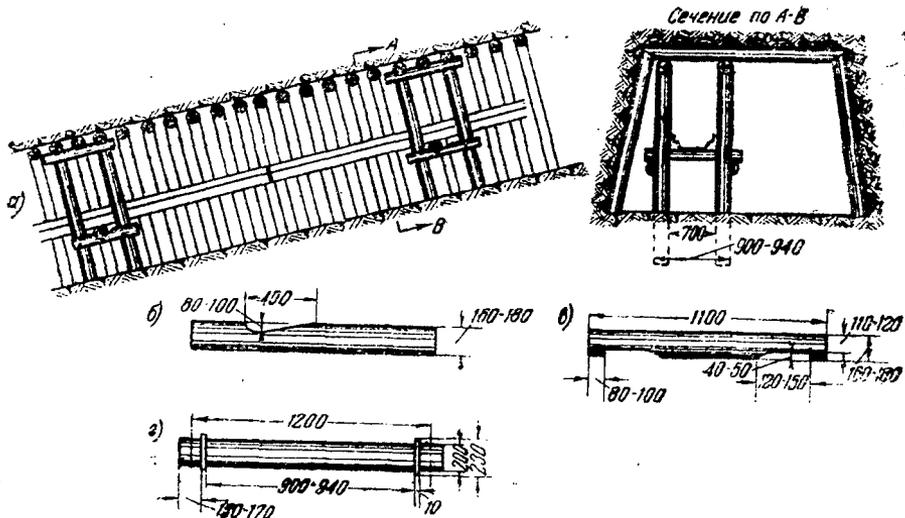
Схема установки конвейера на качалках. а — общий вид установки; б — подхват; в — деревянная качалка; г — качалка из старых труб.
